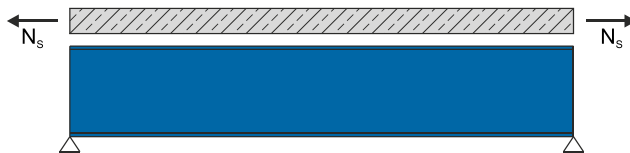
Betonschwinden – Verbundfuge öffnen
